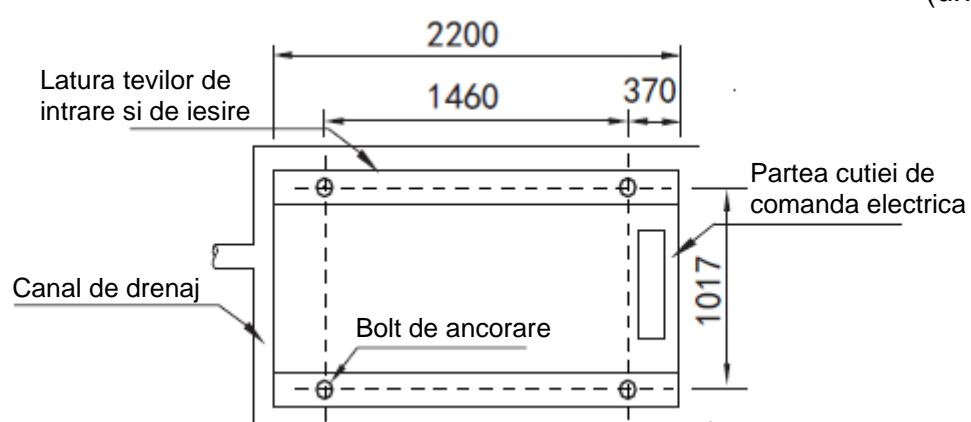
Vedere de sus a schemei dimensionale de instalare a 110 KW
